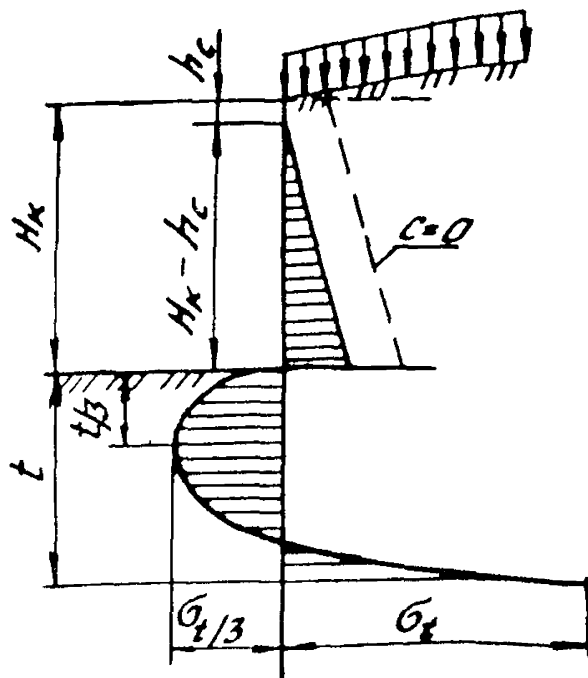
Расчетная схема свайной крепи без анкеров (расстрелов)
